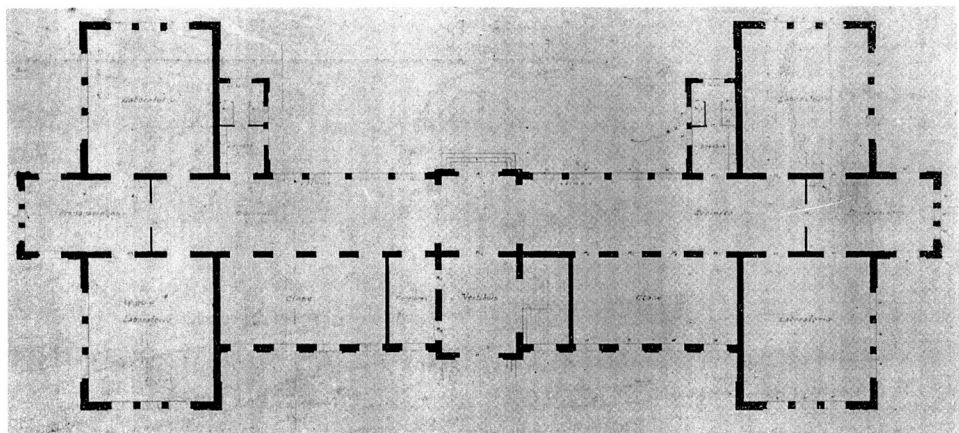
Pabellón de Laboratorios y clases, planta baja del proyecto.
